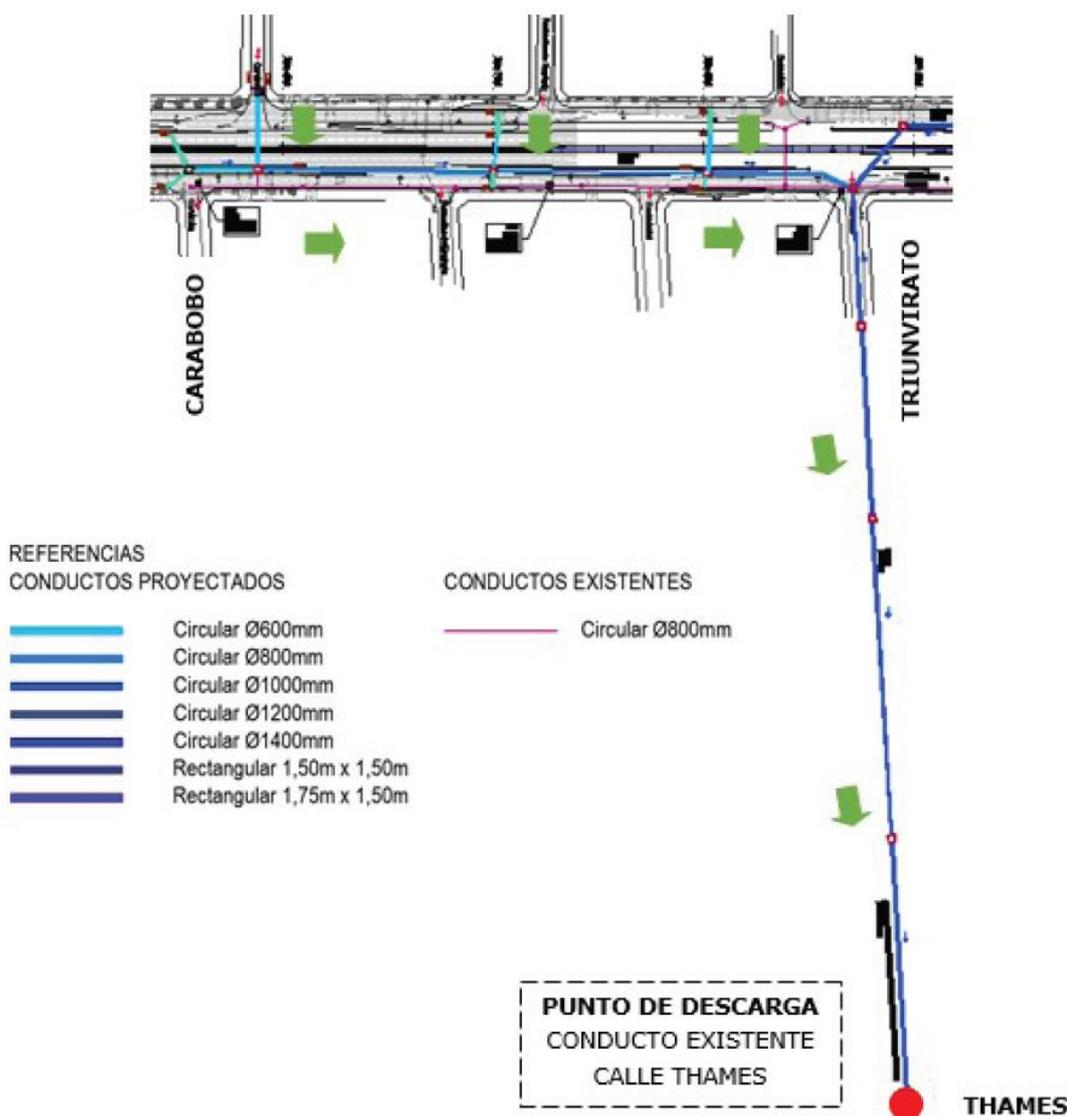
Planta subsistema descarga en conducto existente calle Thames
